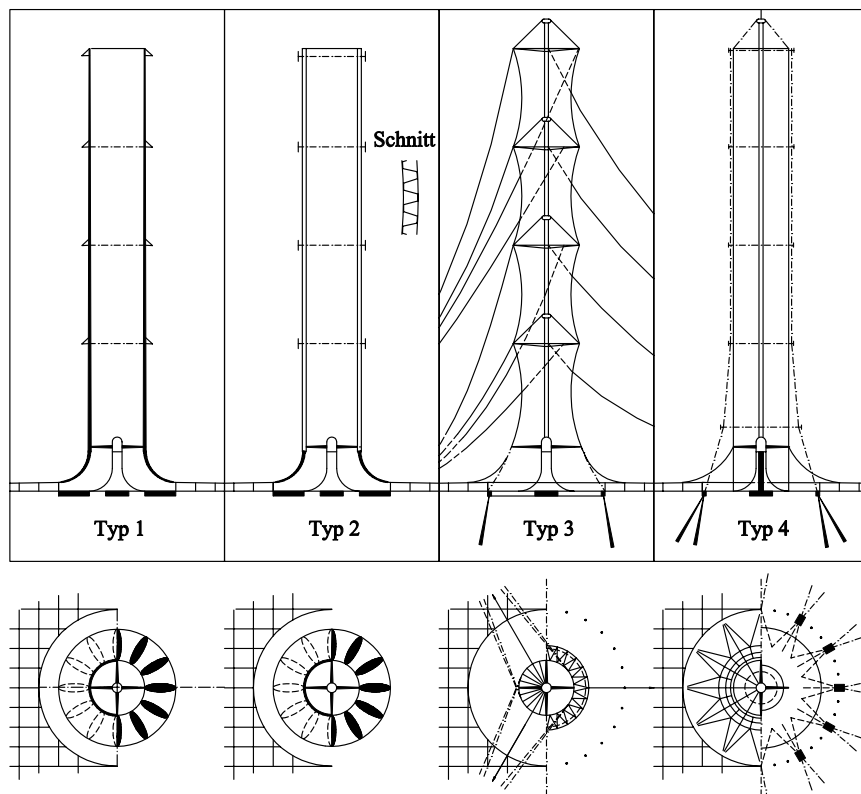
Typ 1: Kaminvariante in Betonbauweise - Kamin in Massivbauweise; Typ 2: Trapezblechröhre in Sandwichbauweise auf Betonfußkonstruktion - Kamin in Leichtbauweise, Stahlblechröhre gelagert auf einer Betonstützkonstruktion; Typ 3: Kaminvariante in Membranbauweise - Kamin in Leichtbauweise, Membrankamin; Typ 4: Sonderkonstruktion „Blechröhre“ mit Seilverspannungen - Kamin in Leichtbauweise, Aufgehängte Stahlblechröhre (nach /Schlaich et al. 1990/)
